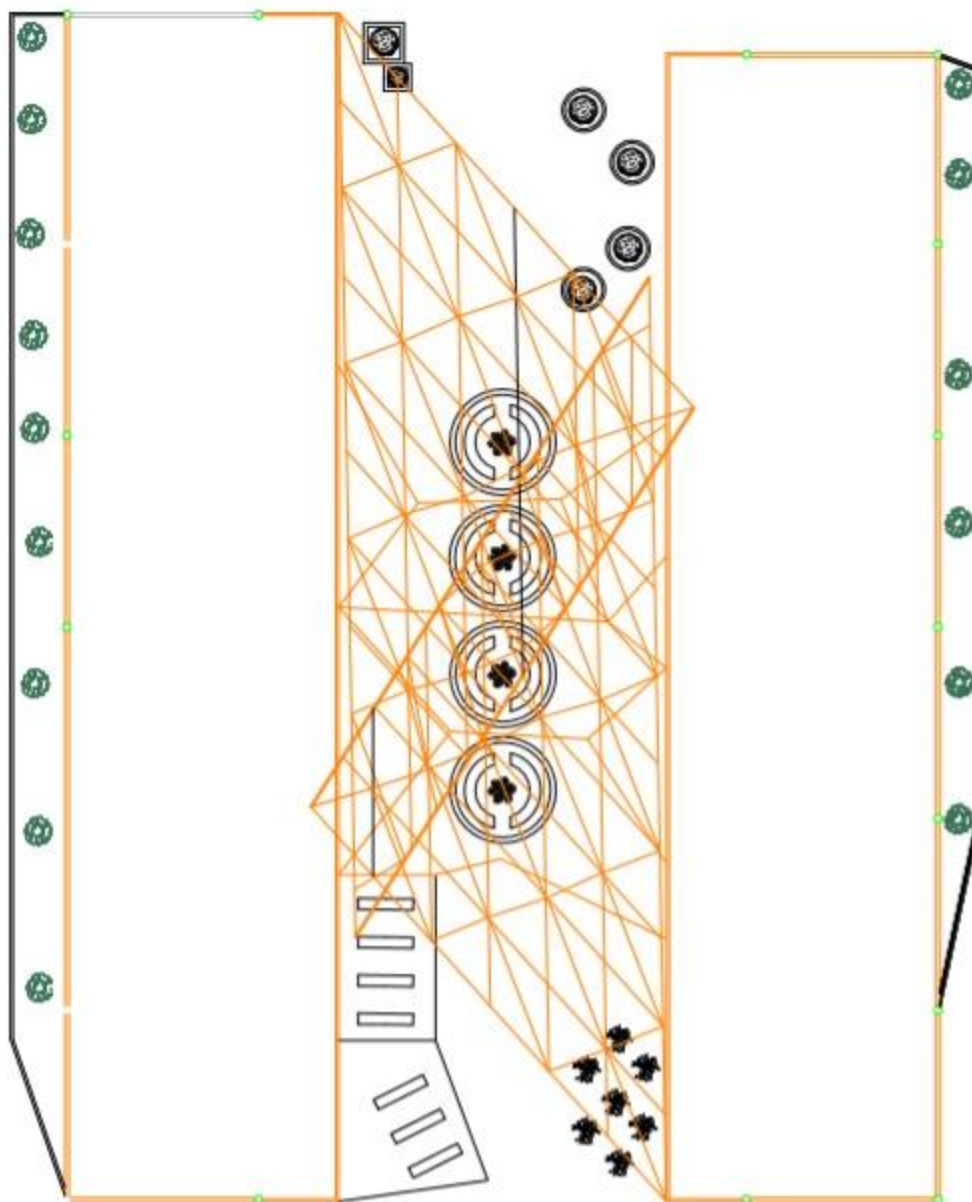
Edificio escolar/Aulas y talleres. Planta arquitectónica.
